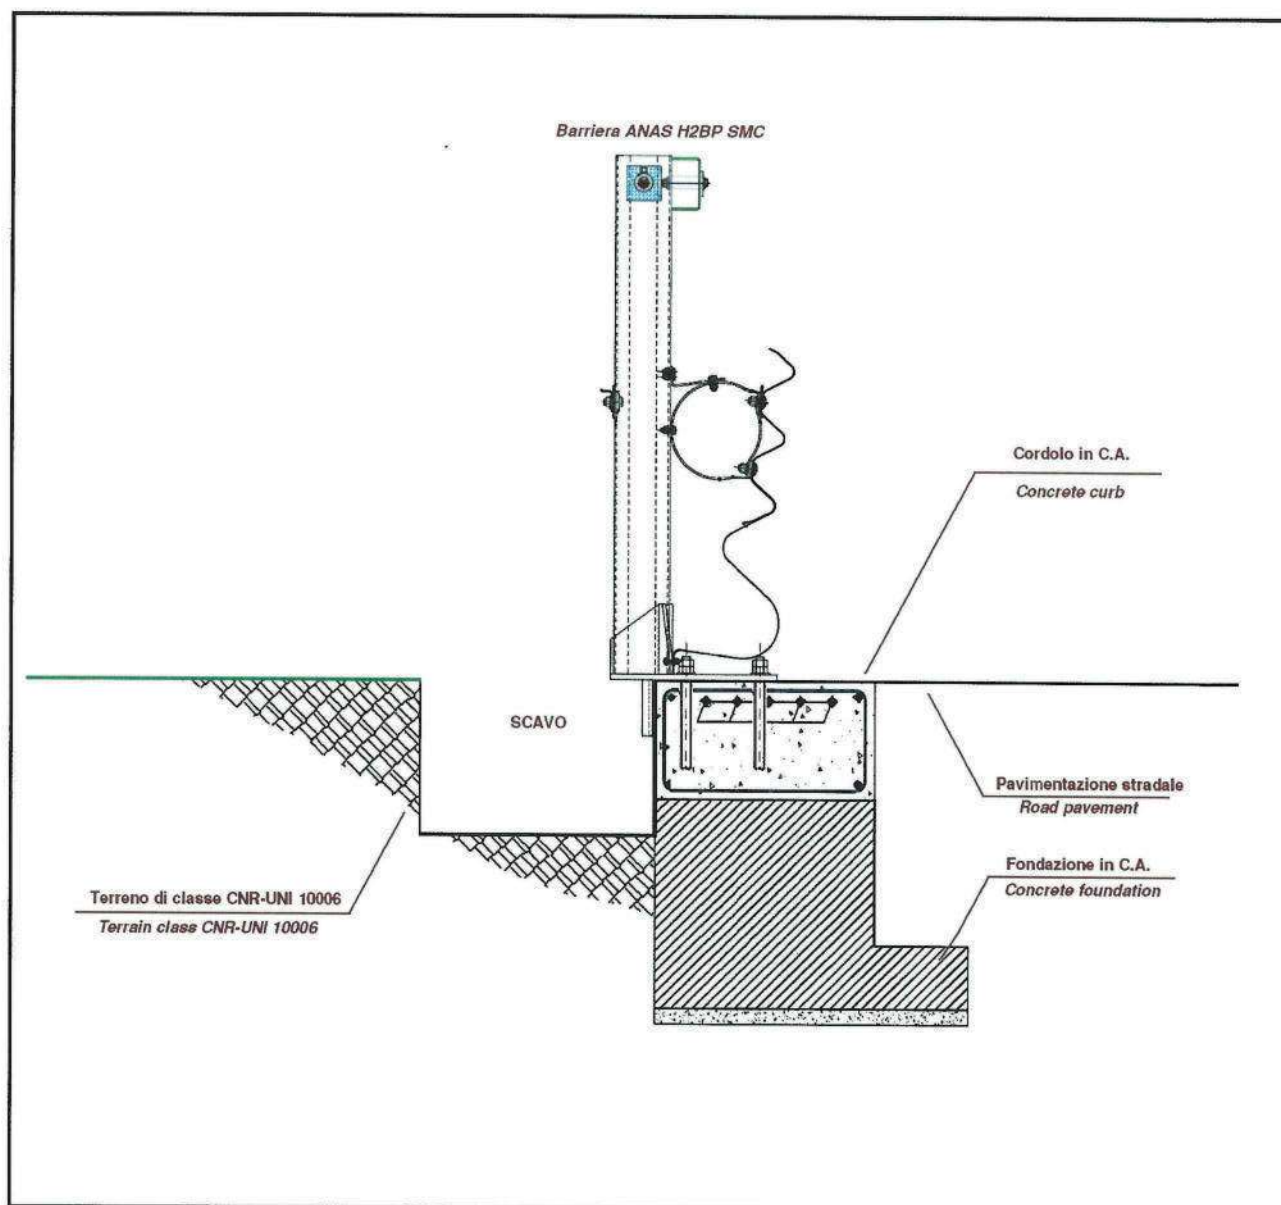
Figure 2 Sezione dell'installazione – The installation section
